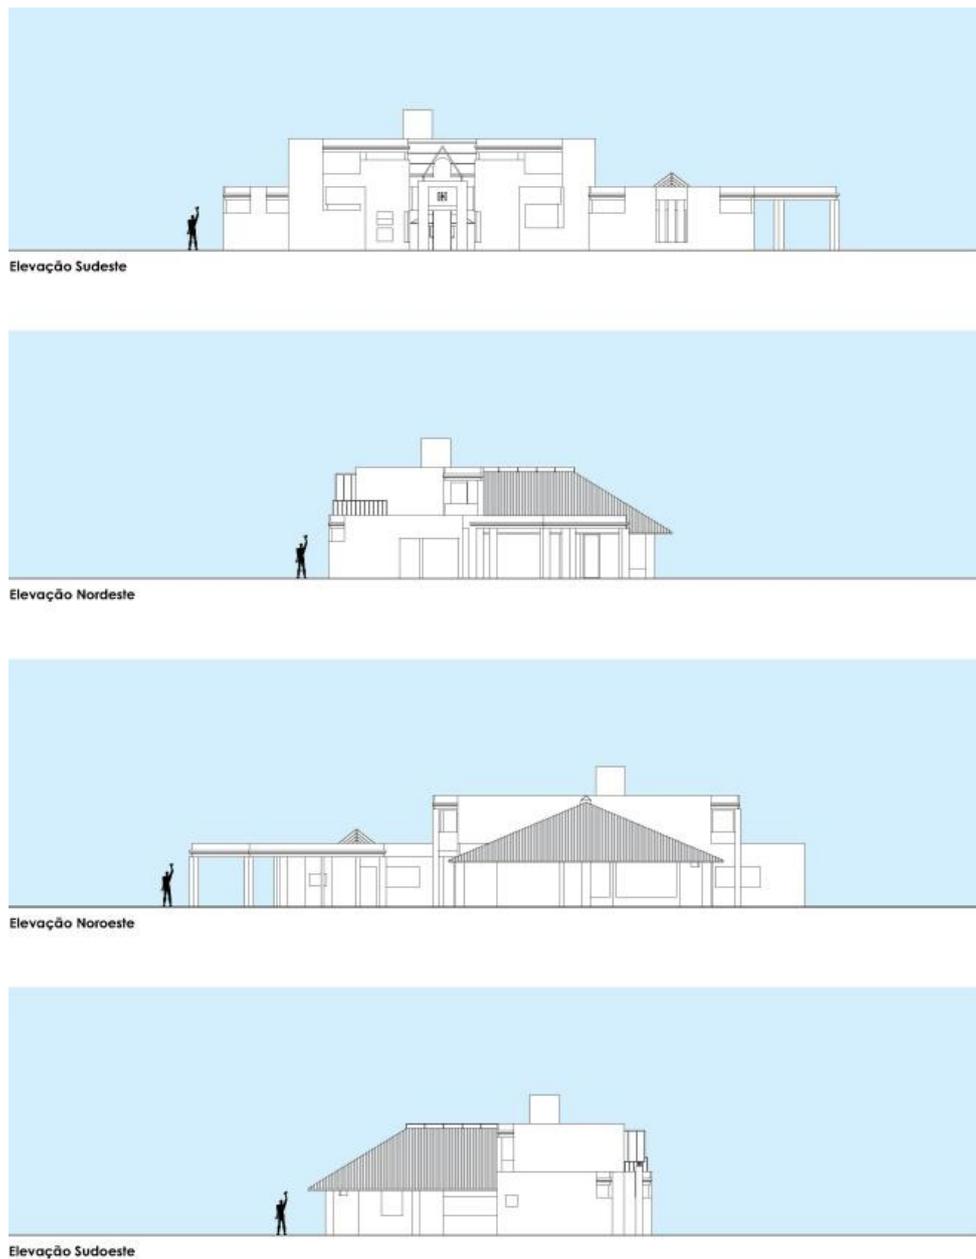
As vistas da Casa J&J. Em sentido horário, temos a fachada principal, com notória distinção volumétrica, formal e conceitual em relação às demais elevações. O telhado tradicional, com telhas de barro, como principal elemento modificador do conceito clássico pós-moderno: mesmo edifício e diferentes leituras. Ilustração feita pelo autor, 2021.
